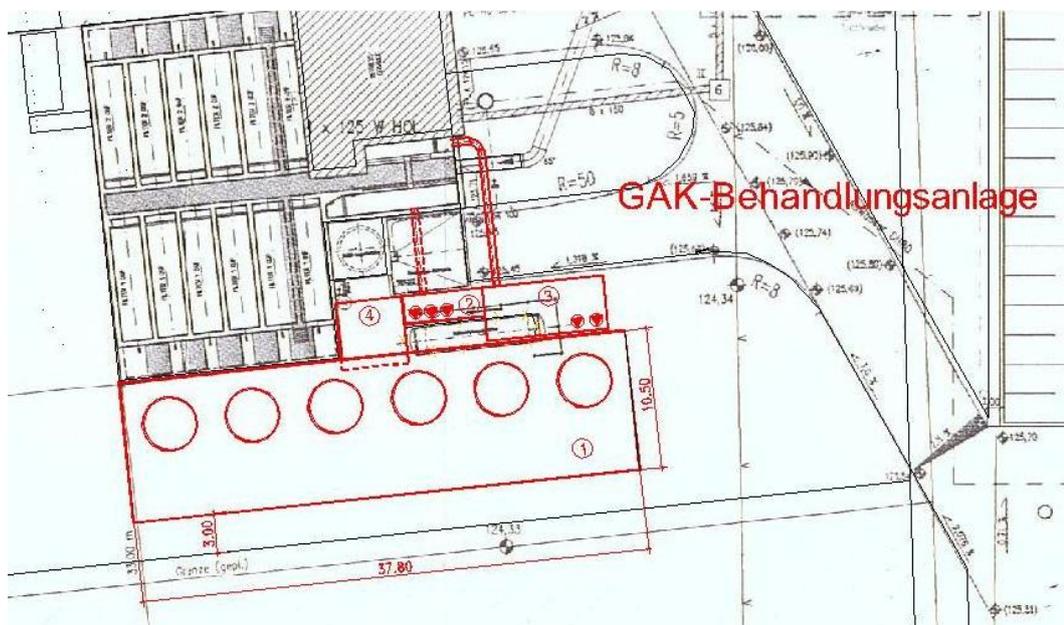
Ausschnitt Lageplan Lösungsvariante 2 – GAK – Nachgeschaltete Druckkessel (1-stufig)
